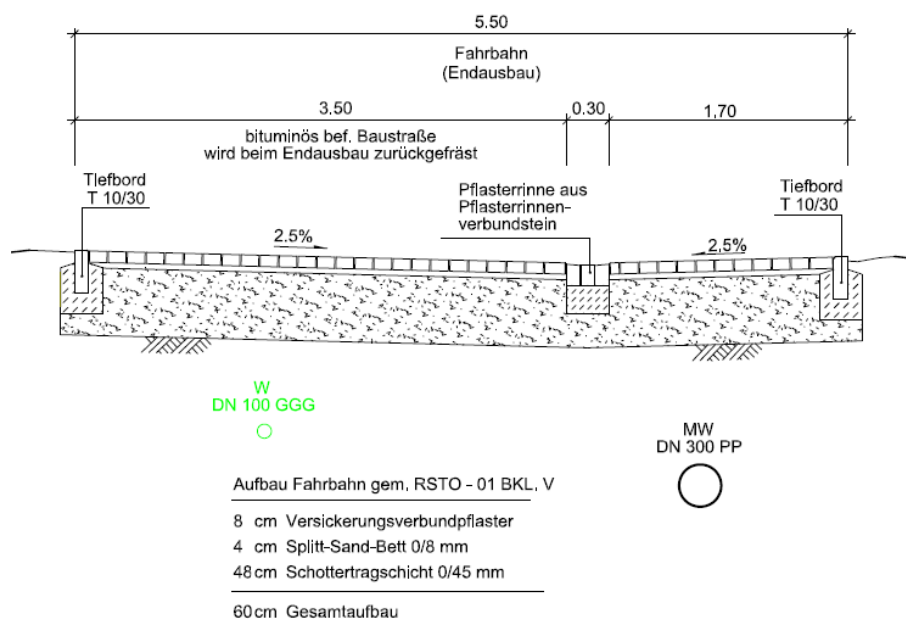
geplanter Querschnitt der Erschließungsstraße im Plangebiet (Quelle: Kolb & Küllmer, Vor- und Entwurfsplanung, Stand 31.07.2013)
